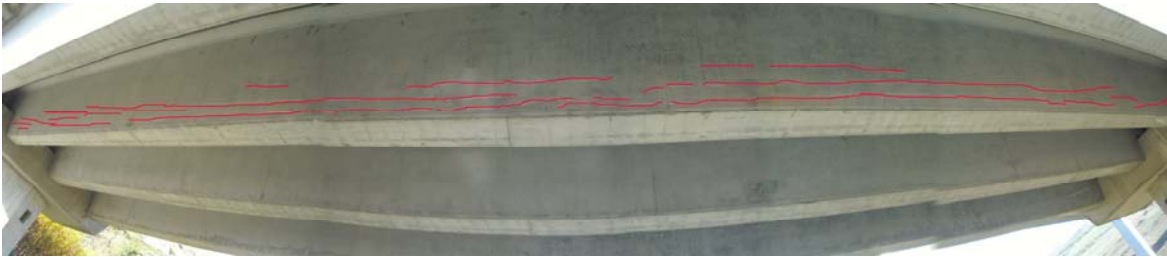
Fisuras en horizontales en tableros de vigas
